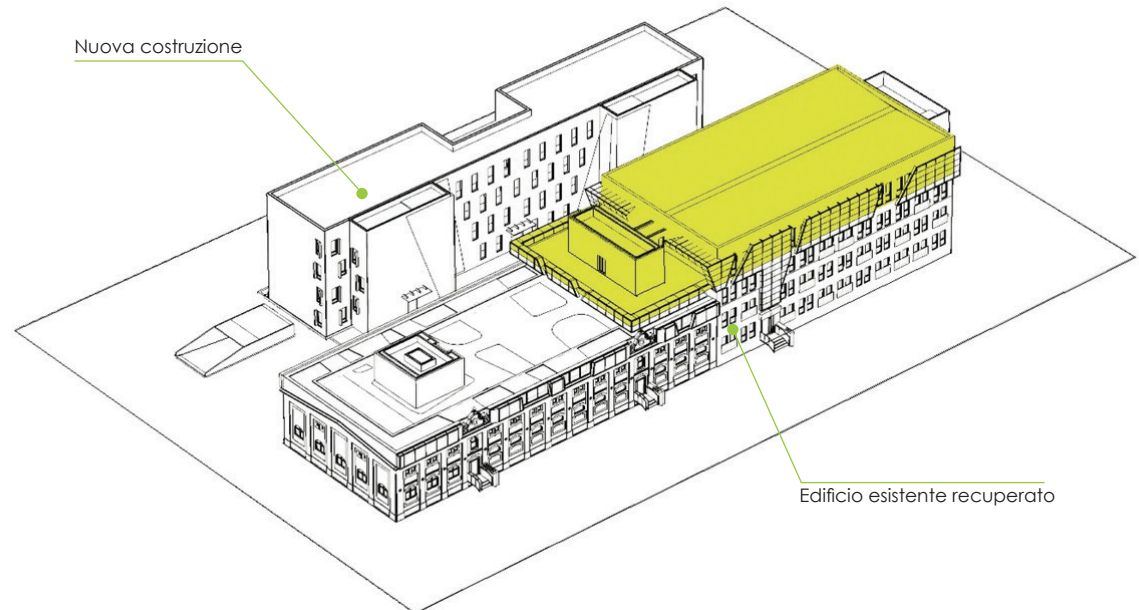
Assonometria del progetto; Fonte: <http://www.nanowoarchitekci.pl/>;
